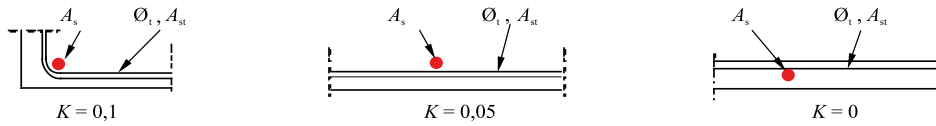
Valores de K para vigas y losas (Figura 8.4 de UNE-EN 1992-1-1)
